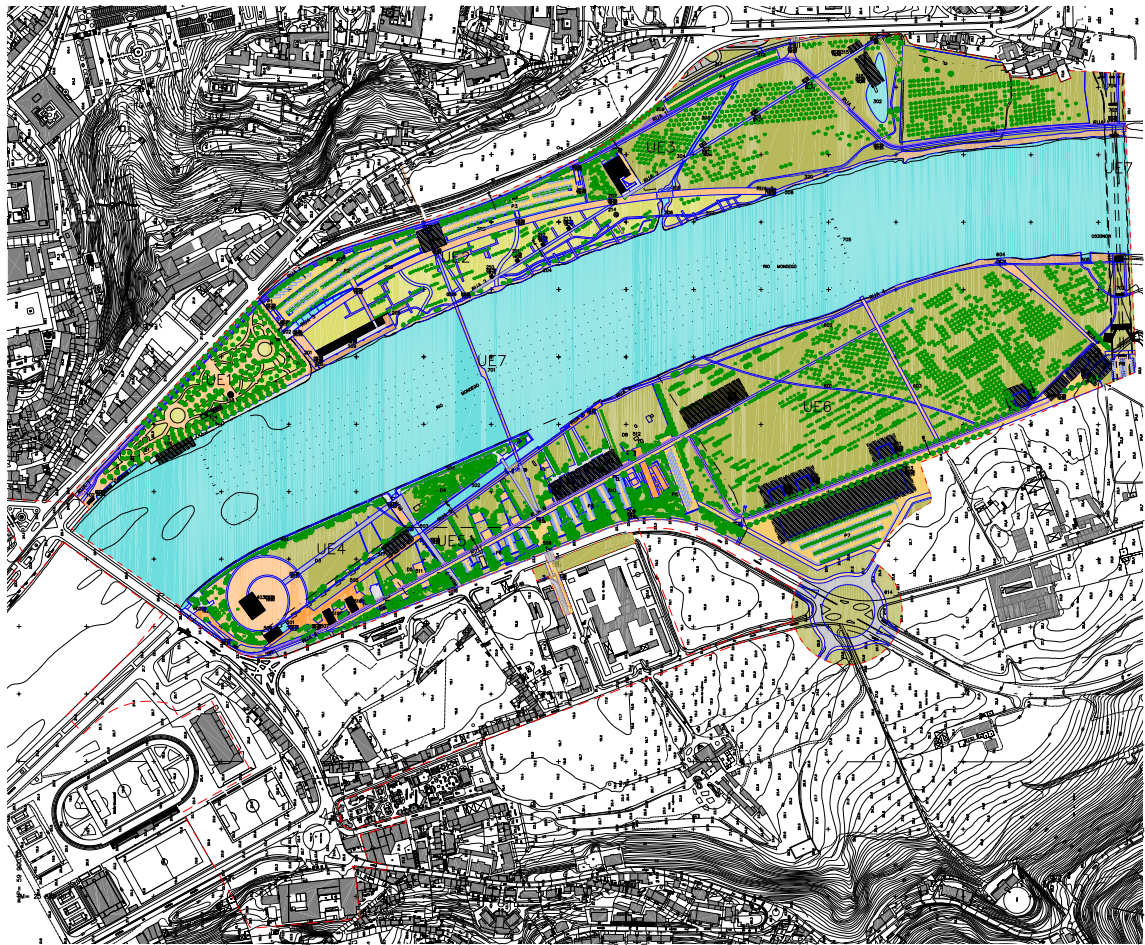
Planta do Plano de Pormenor do Parque Verde do Mondego - MVCC Arquitectos
